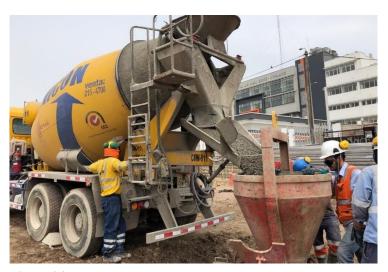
Vaciado de concreto Fuente: Elaboración propia
